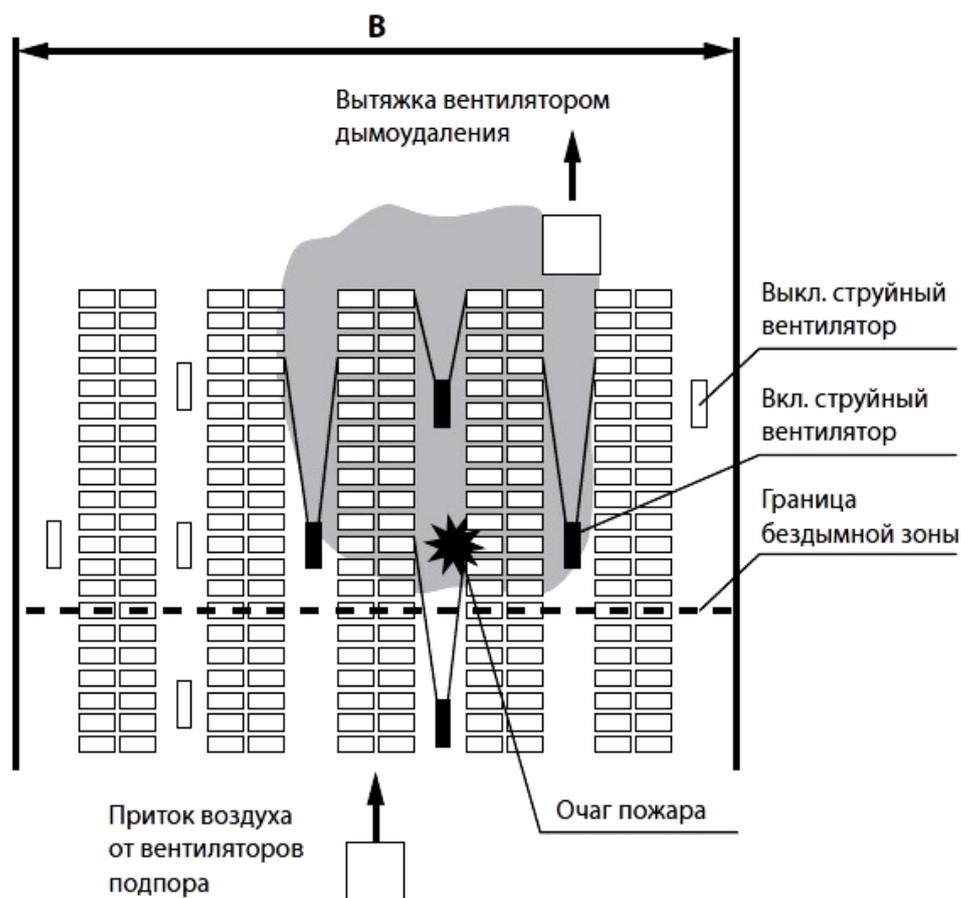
Схема работы системы струйной вентиляции при продольной системе противодымной вентиляции
